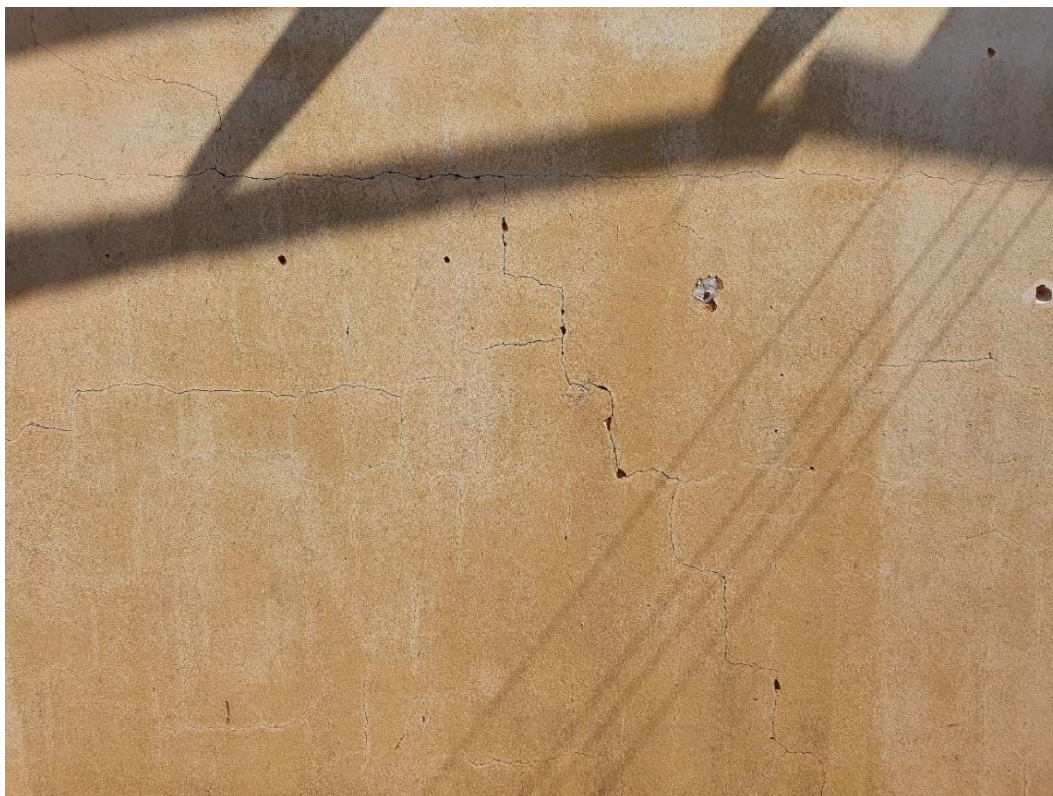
Parede externa da cozinha apresenta rachaduras horizontais e em ângulo
